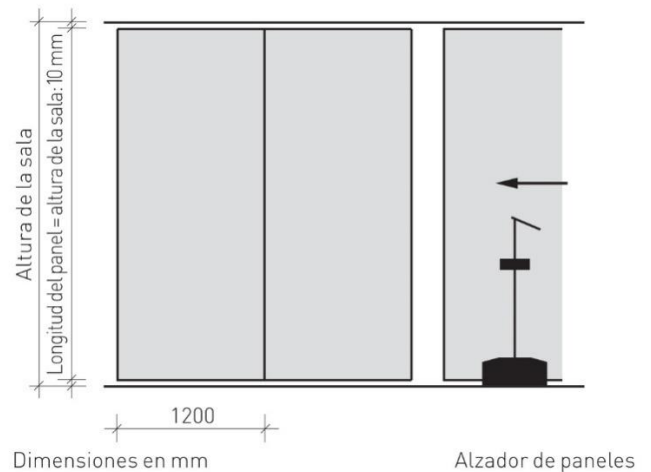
Instalación de las placas por junta pegada con alzador (distancias en mm).
